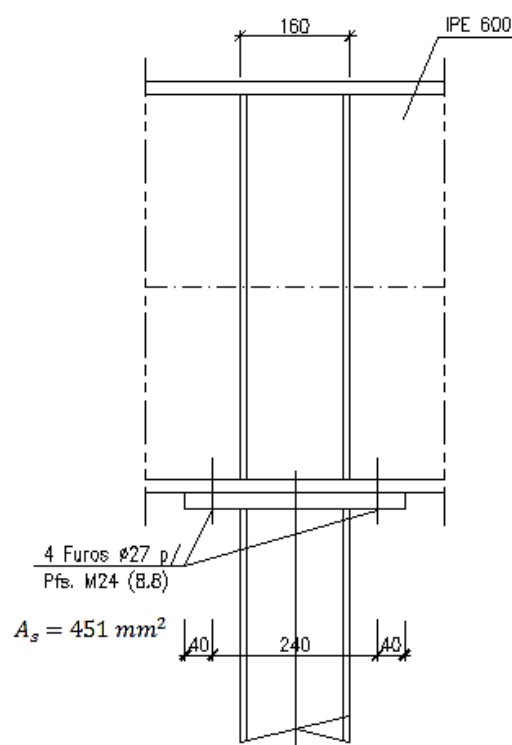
Ligação viga-pilar semi-rígida, com viga suportada directamente pelo pilar (Cima Gomes; Biscaia, N., 2008)
